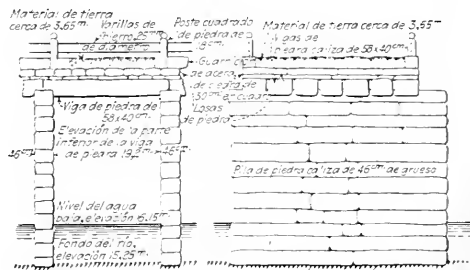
DETALLES DE CONSTRUCCIÓN DEL PUENTE CHINO
